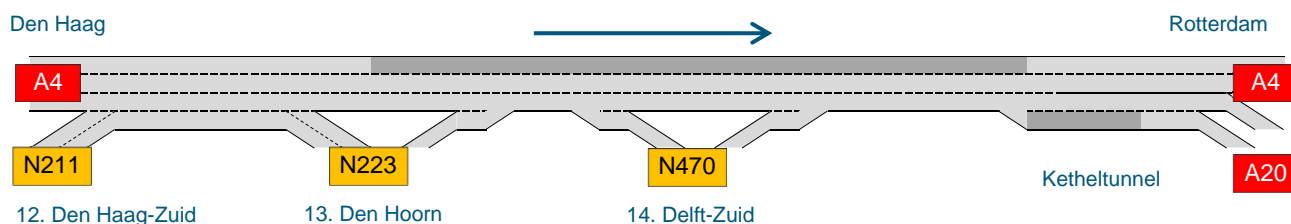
toont de rijstrookindeling van de A4 links tussen de Ketheltunnel en Den Hoorn in de situatie zonder scope-uitbreiding. In de Ketheltunnel liggen 4 rijstroken in noordelijke richting. Na de tunnel valt de linkerrijstrook af, en is er sprake van 3 doorgaande rijstroken. Ter hoogte van aansluiting Delft-zuid valt nogmaals de linkerrijstrook af. Tussen Delft-zuid en Den Hoorn heeft dit deel van de A4 slechts 2 rijstroken. Ter hoogte van aansluiting Den Hoorn breidt de A4 uit naar 3 rijstroken, als onderdeel van het project A4 Haaglanden-N14.
